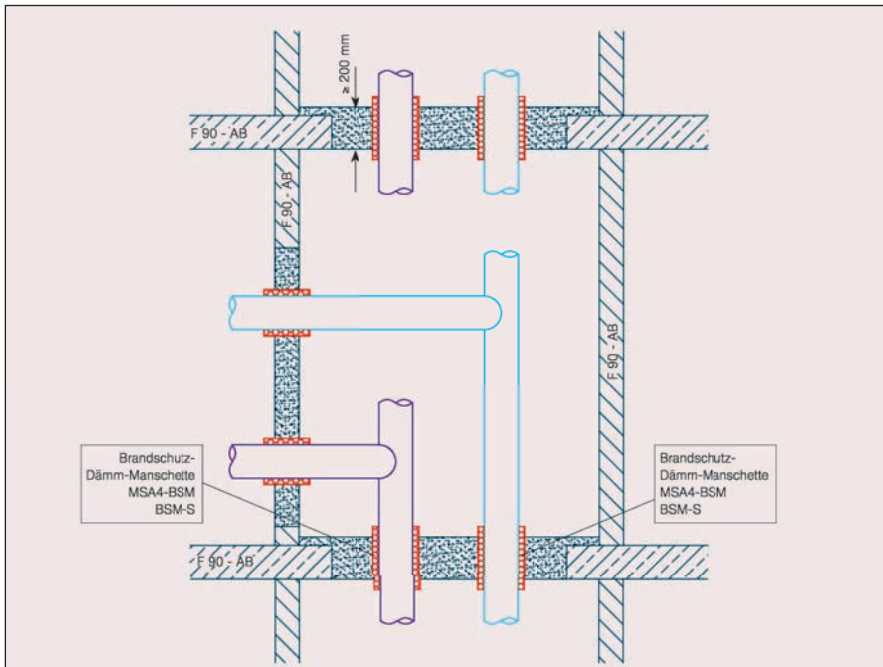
Mischinstallation von Sanitär- und Heizungsleitungen in einem F90-Installationsschacht nach DIN 4102-4
